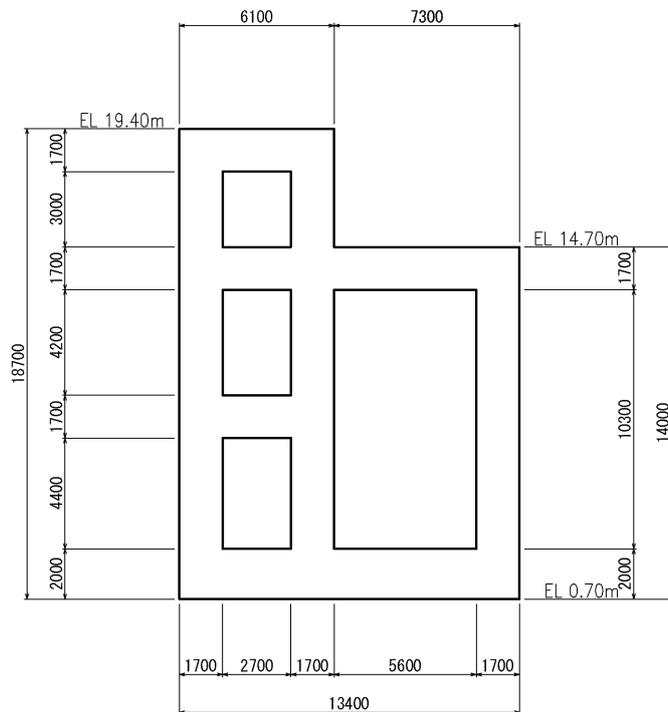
第1 ベントフィルタ格納槽 断面図 (A-A 断面)
